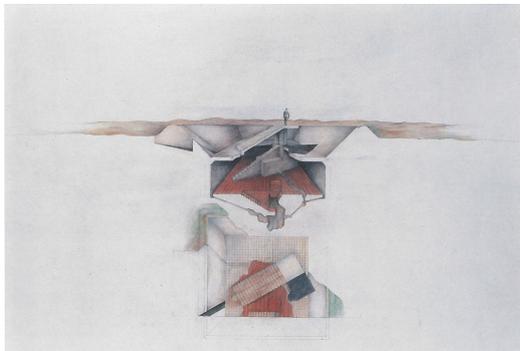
1973. House with Two Horizons. 10 Houses. The Imaginary House. Planta e Corte Perspetivado.
